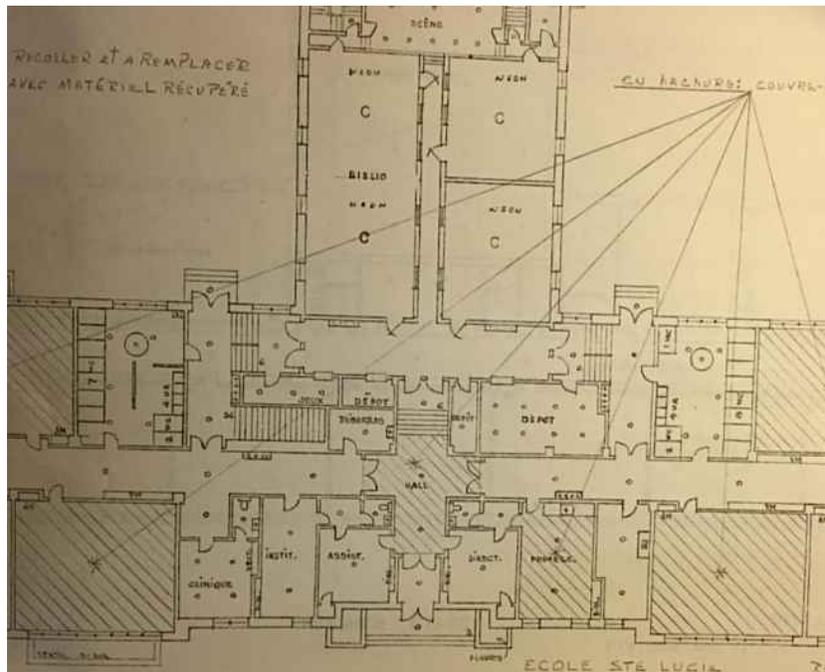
Plan partiel montrant l'organisation intérieure du rez-de-chaussée et la disposition des marches donnant accès au gymnase. Le plan montre également le réaménagement du gymnase avec les nouvelles partitions.
